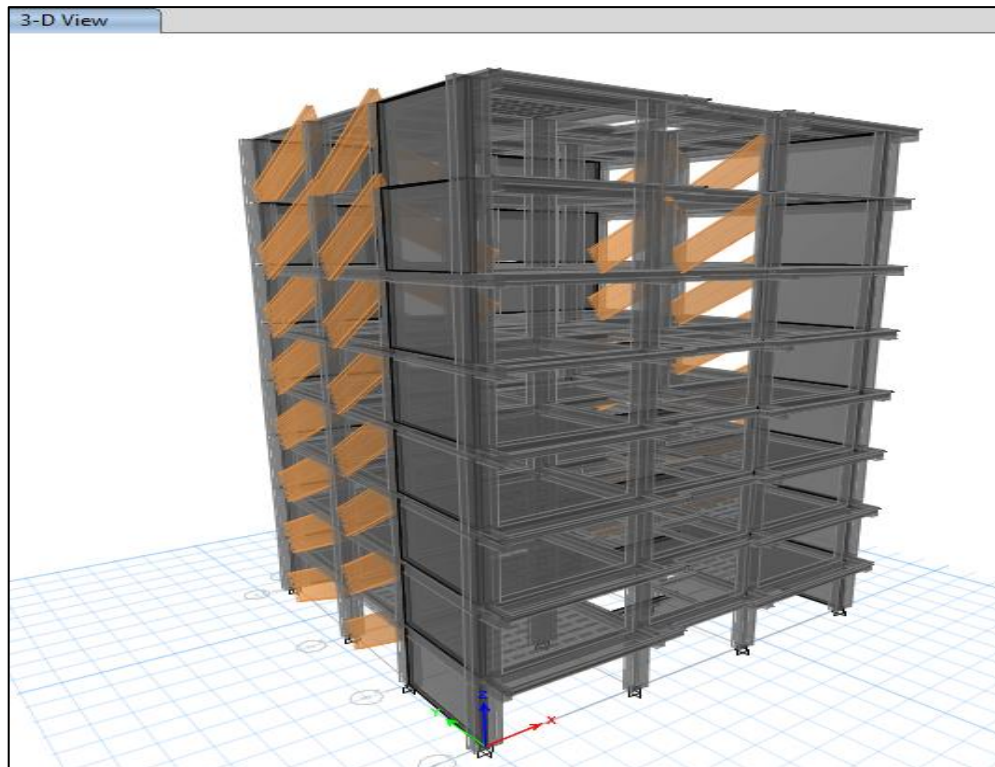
Modelamiento de concreto con tabiquería-Pandereta.
